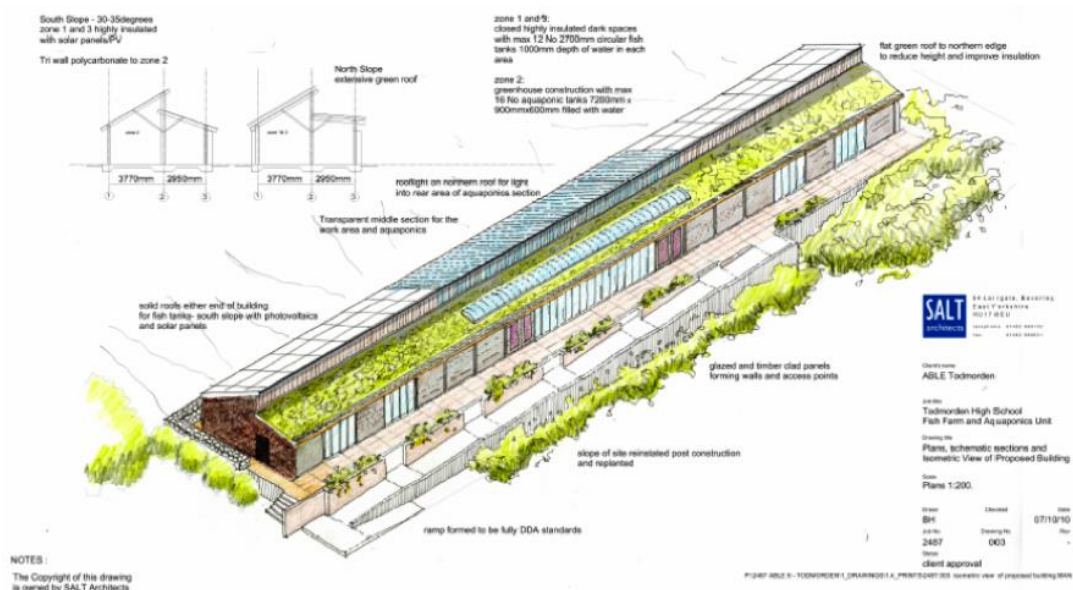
Plan du Fishy Food Hub (Source : Site Internet de Green Future Building, octobre 2012)
